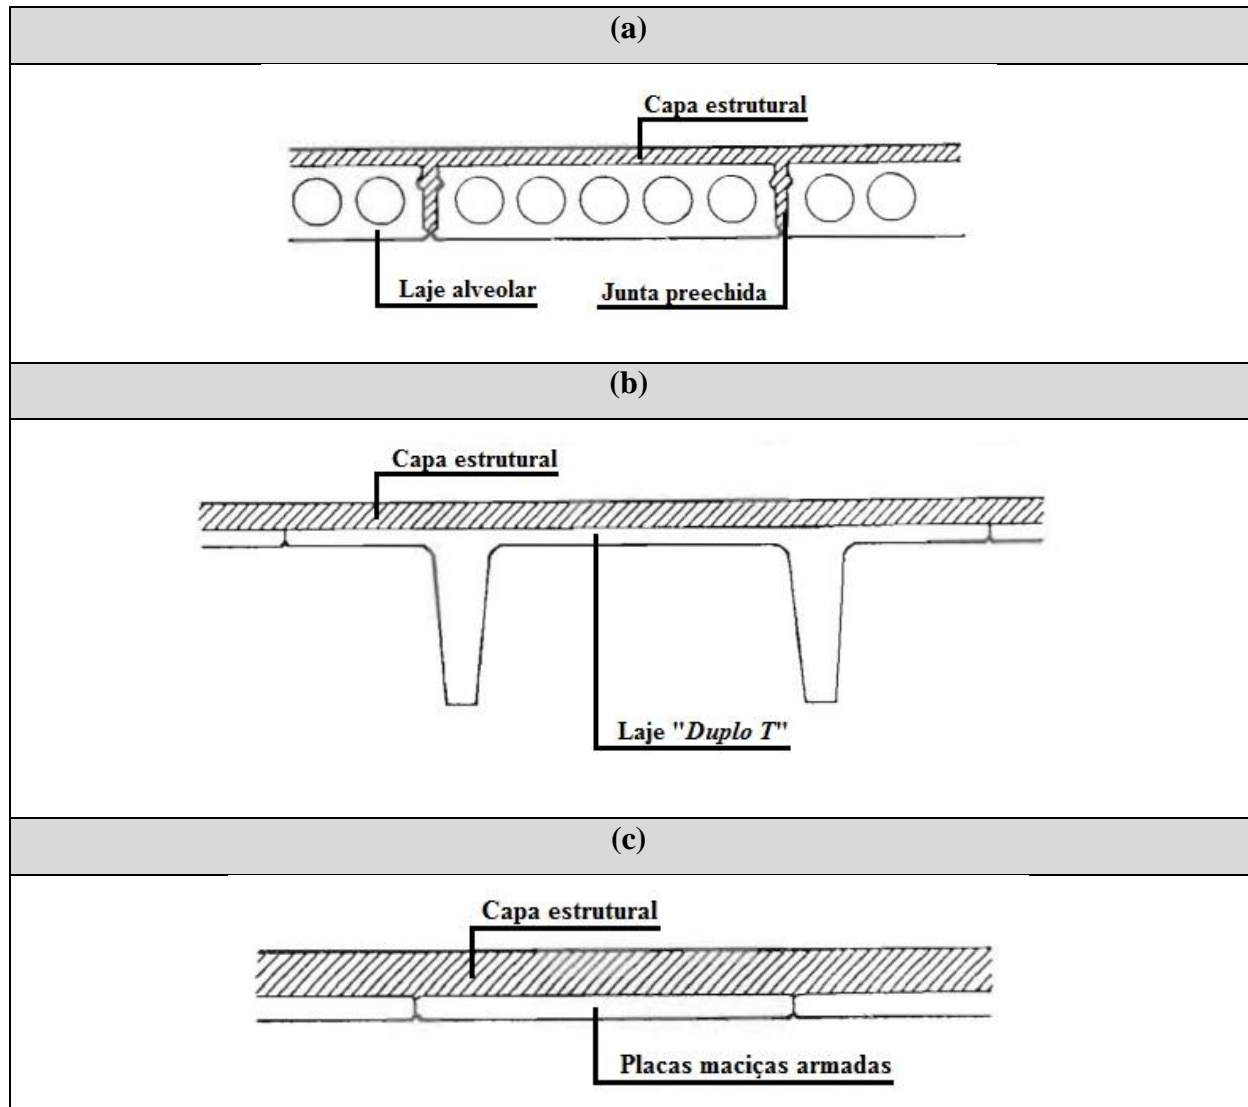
16 – Algumas seções padrões de lajes pré-fabricadas com a aplicação de capa estrutural: (a) Laje alveolar; (b) Laje Duplo T; (c) Placas maciças (BASEADO EM: FIP, 1998).
